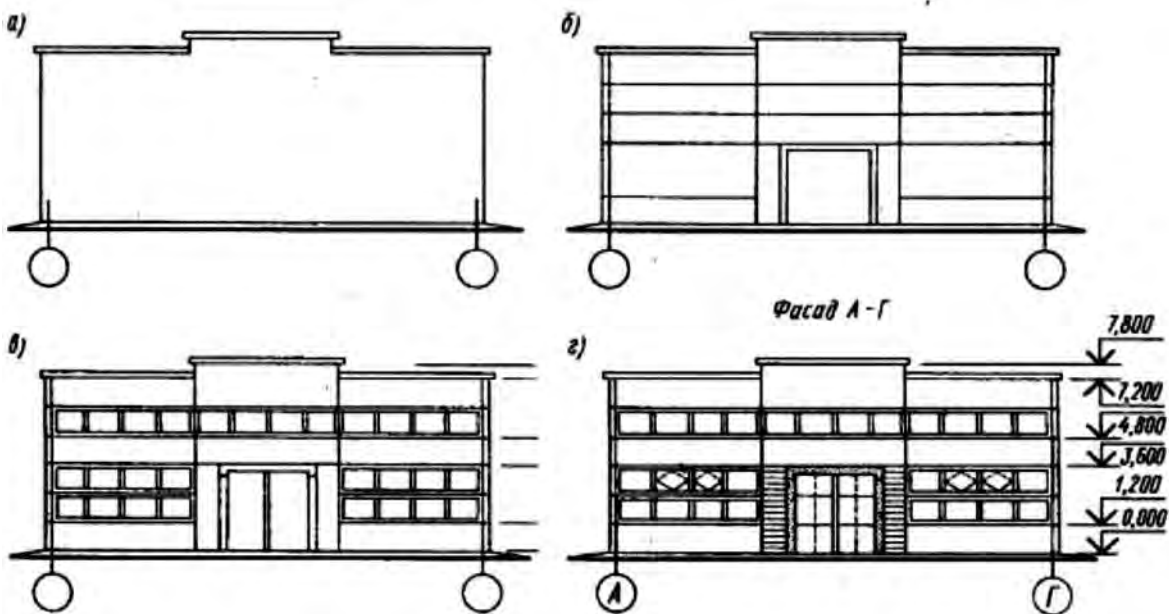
Послідовність викреслювання фасаду будівлі
